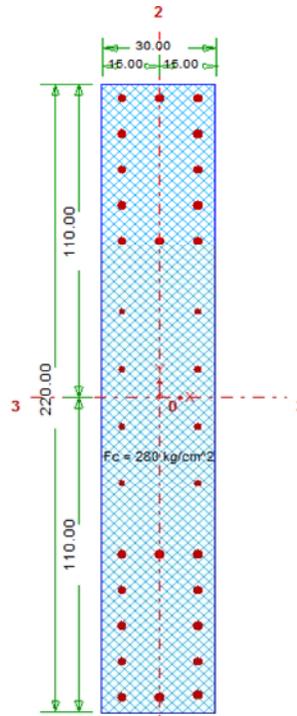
Armado Preliminar por Flexión para la Placa en Estudio PL-05.
